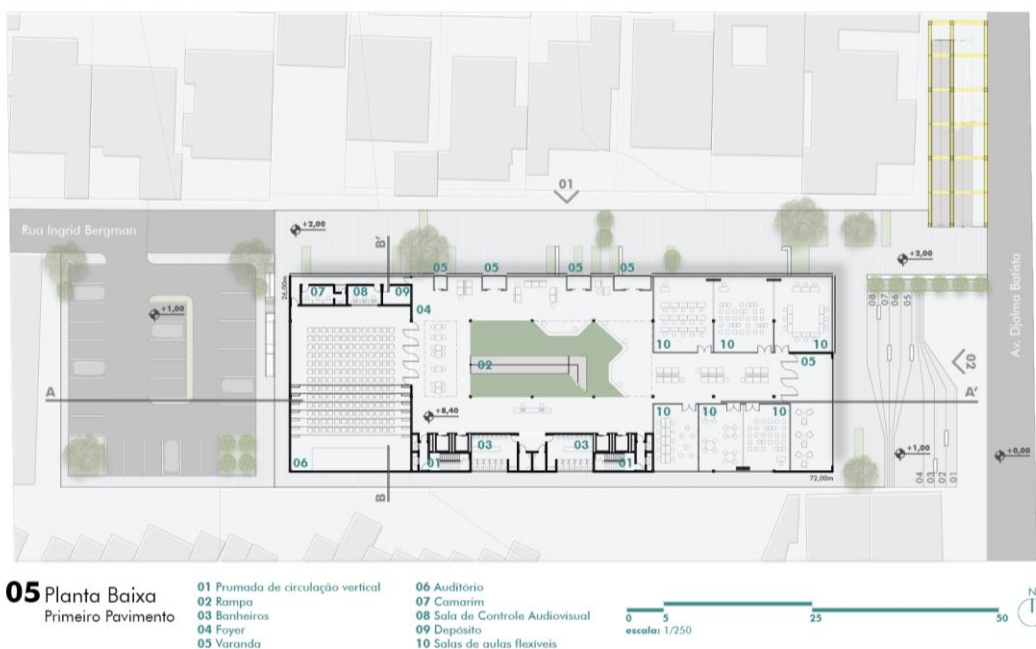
Planta Baixa Primeiro Pavimento. Fonte: acervo da autora, 2021
